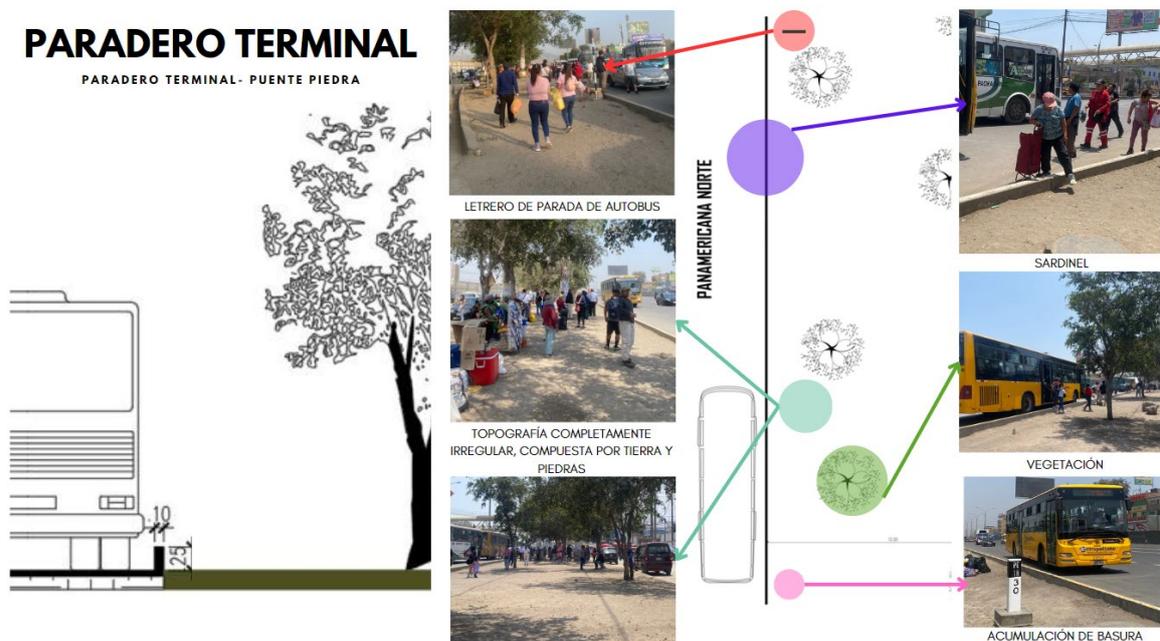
Paradero terminal - Puente Piedra. Fuente: elaboración propia.
